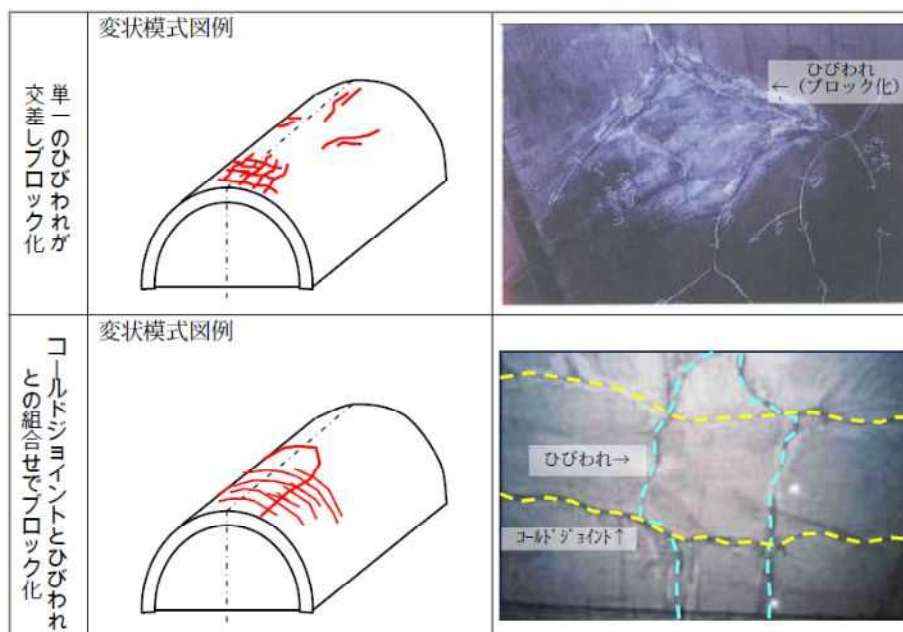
ひび割れによる覆工コンクリートはく落概念図
